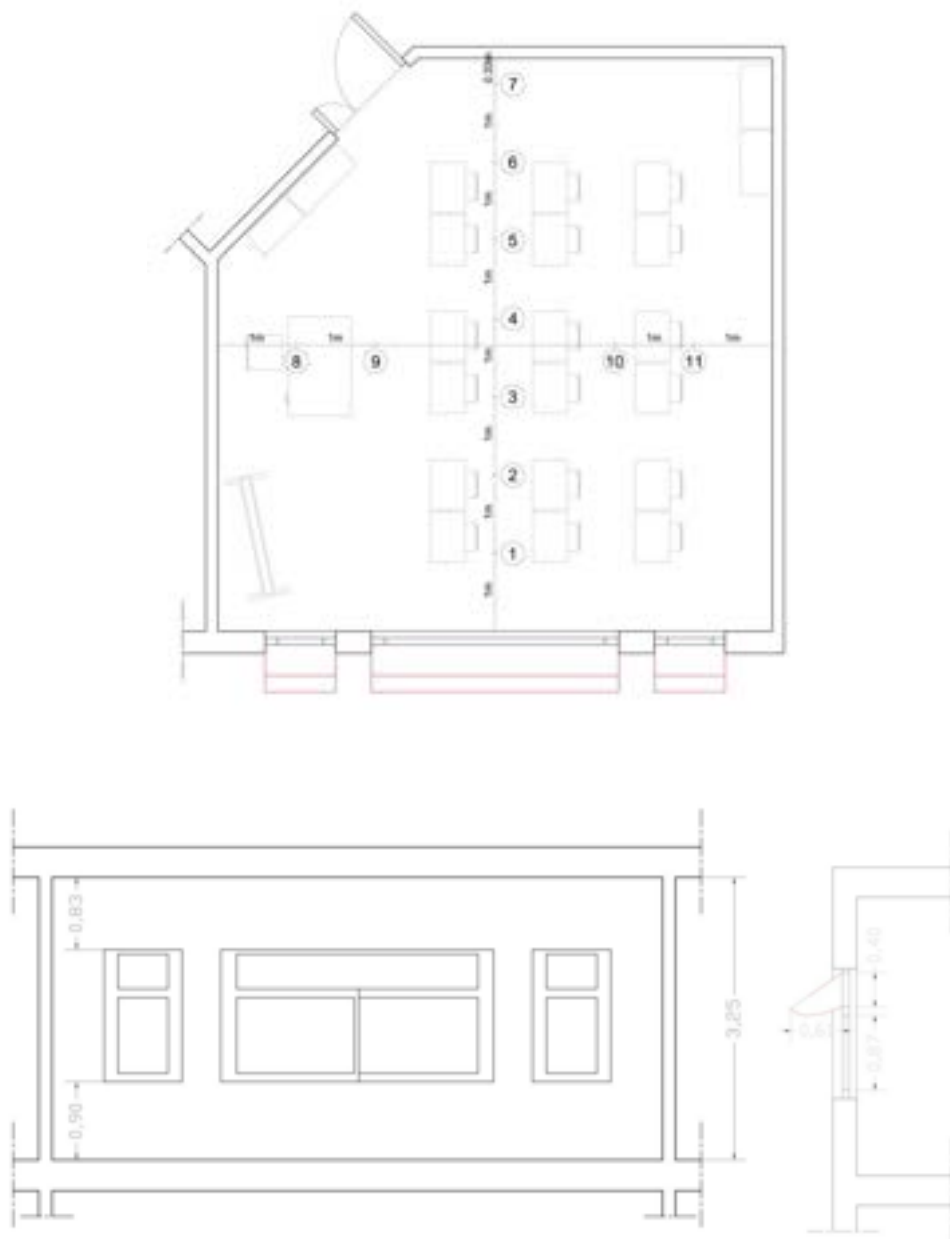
Illustrazione dell'applicazione del sistema di daylighting in pianta, sezione e sezione trasversale della parete esterna
